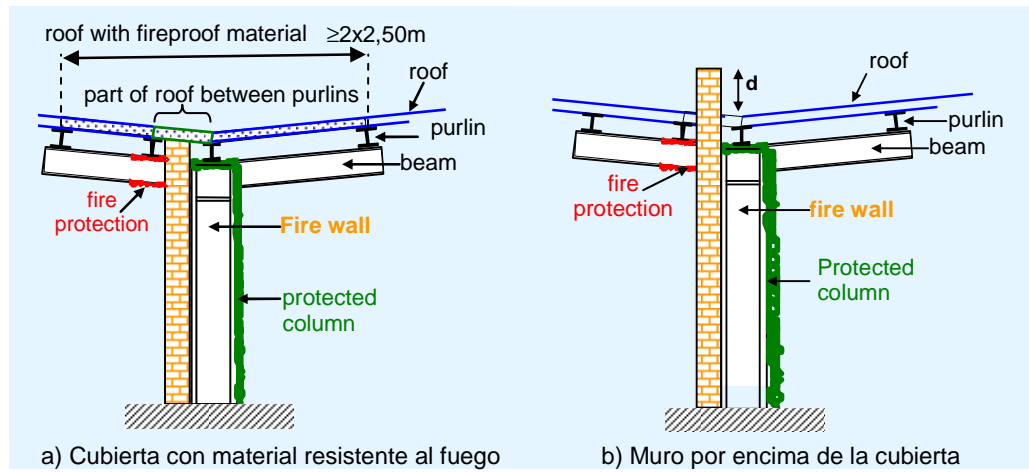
Sistema de cubierta por encima de los elementos de separación
